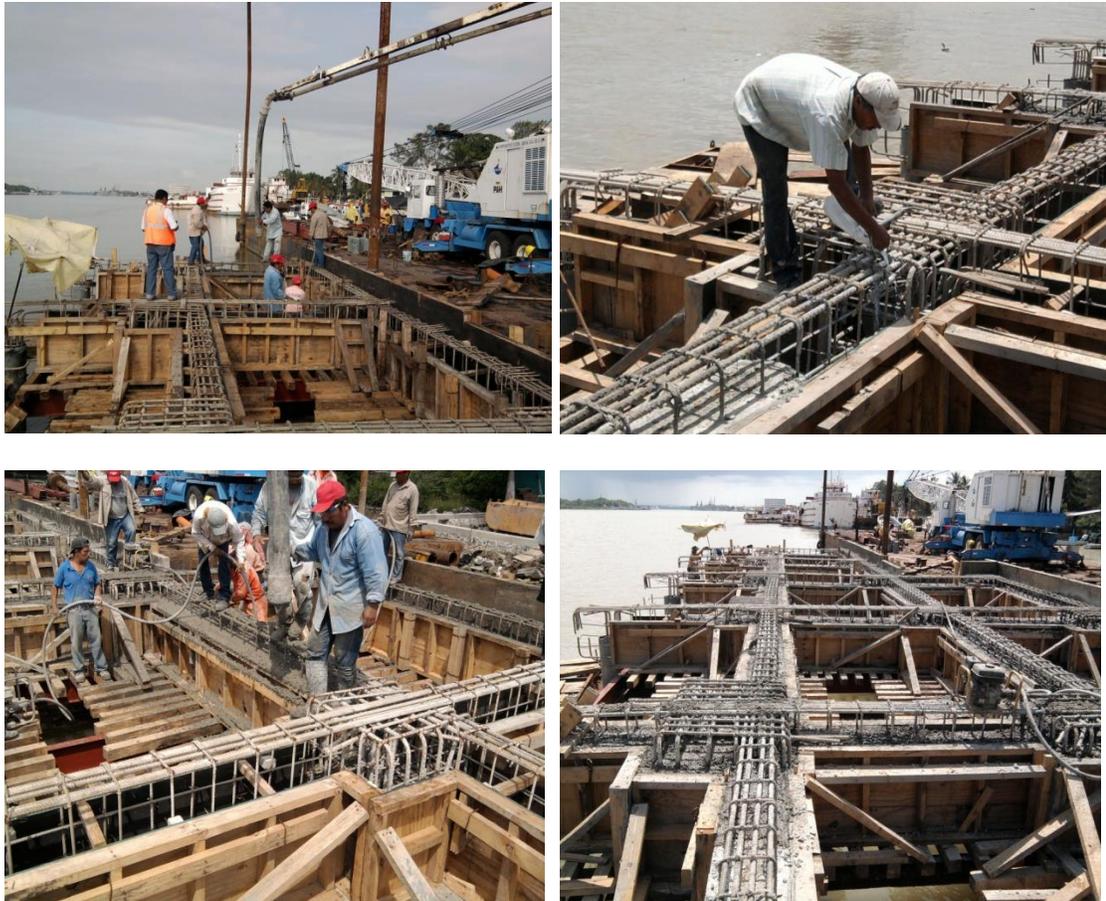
Colocación de concreto (colado) en pilotes, cabezales y traveses entre los ejes del 6 al 1 y del D a G, del muelle.
